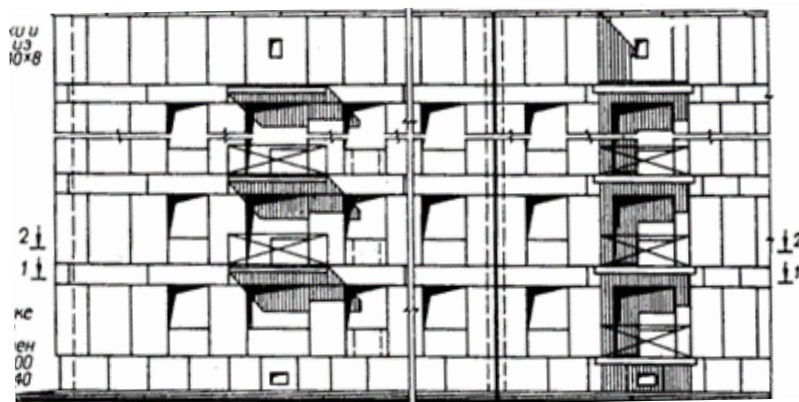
Фасад житлового багатоквартирного будинку із крупних легкобетонних блоків
